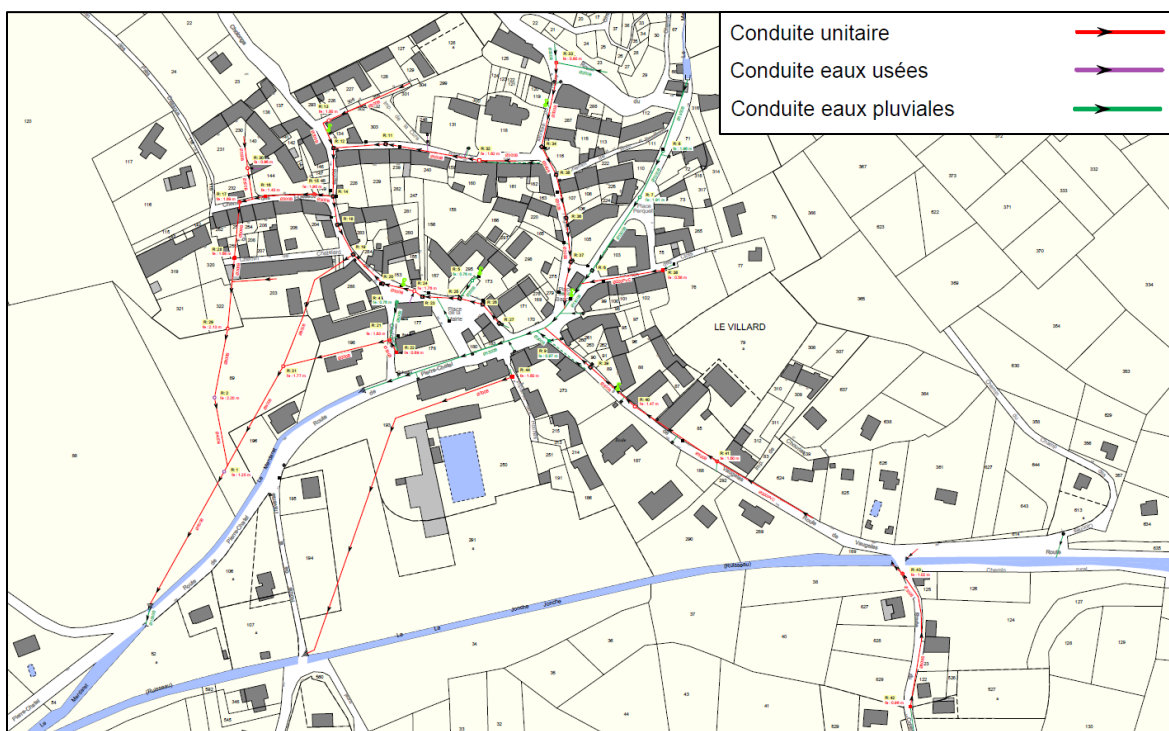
Extrait du plan des réseaux d'eaux usées - Village
